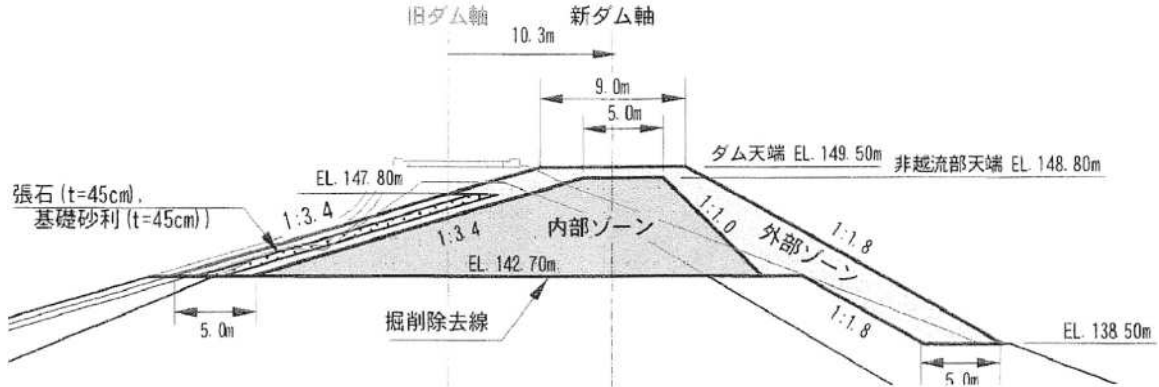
衣川1号ダム復旧(補修)横断面図
